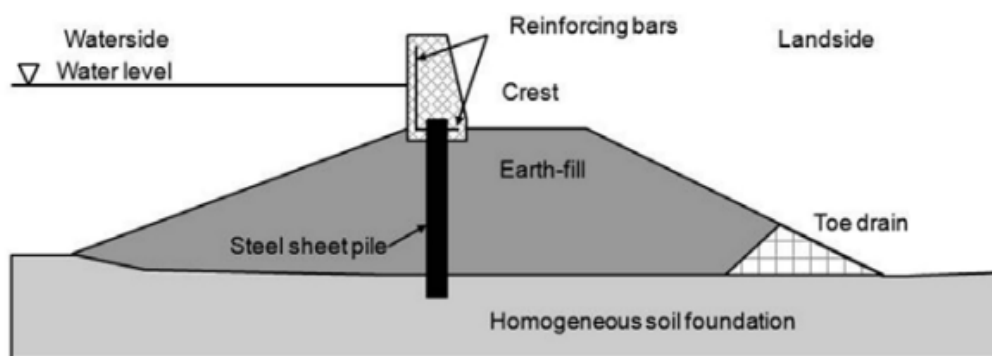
Esempio sezione con muro a gravità e diaframma [CIRIA et al., 2013]
